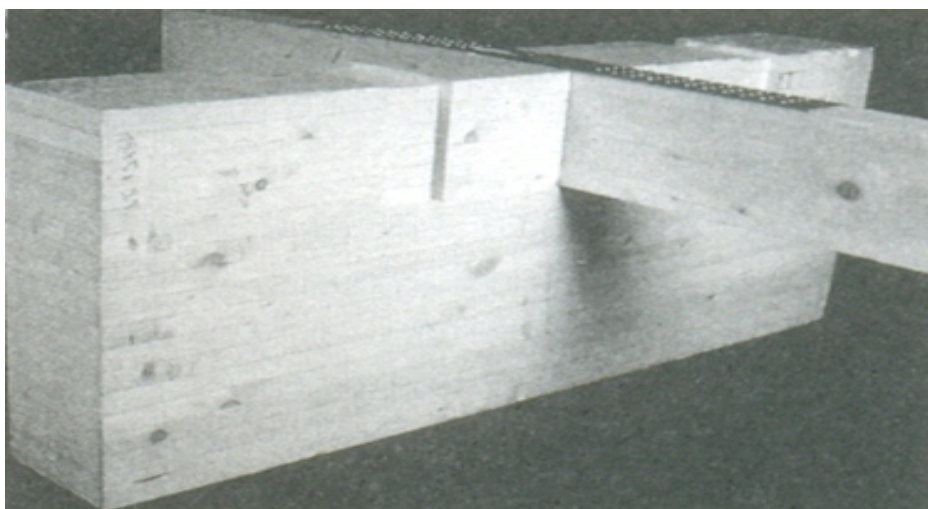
Apoio de barrote com cobre-junta sobre viga principal. Fonte: Natterer (1998)
